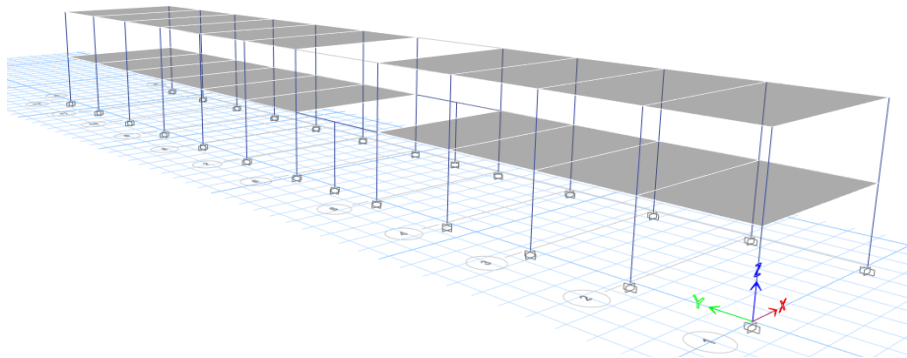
Modelamiento en ETABS 2018 pabellón 2
